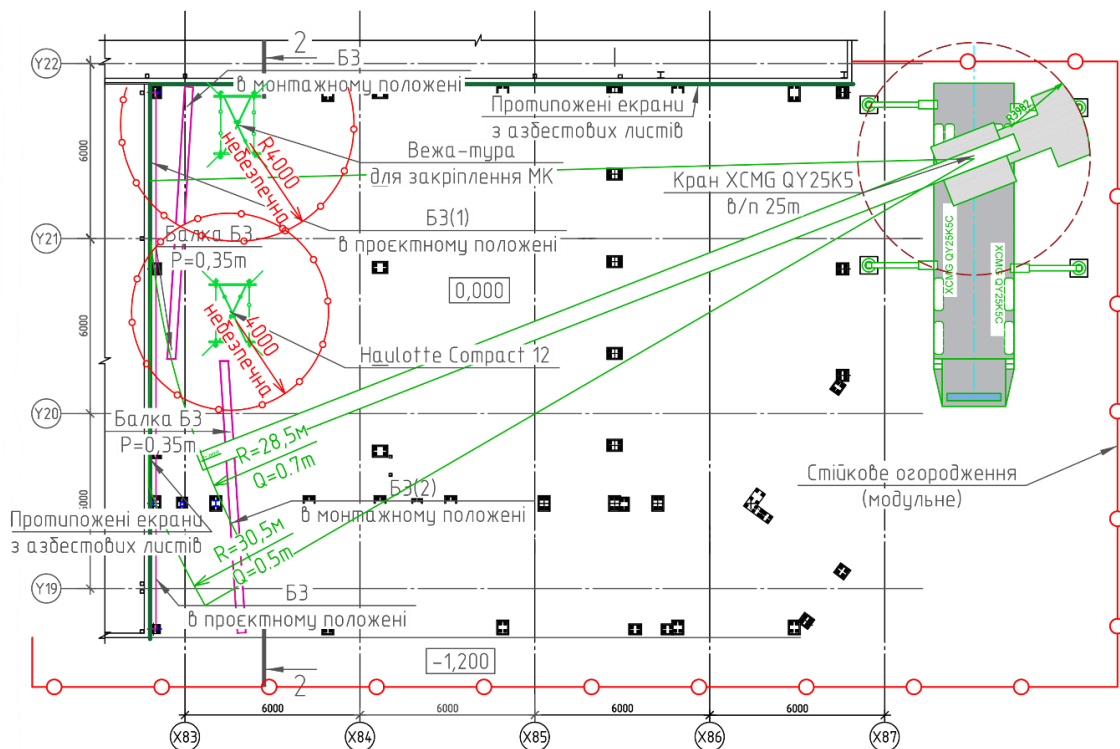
Схема монтажу балки Б3 в осях Y22-Y19
